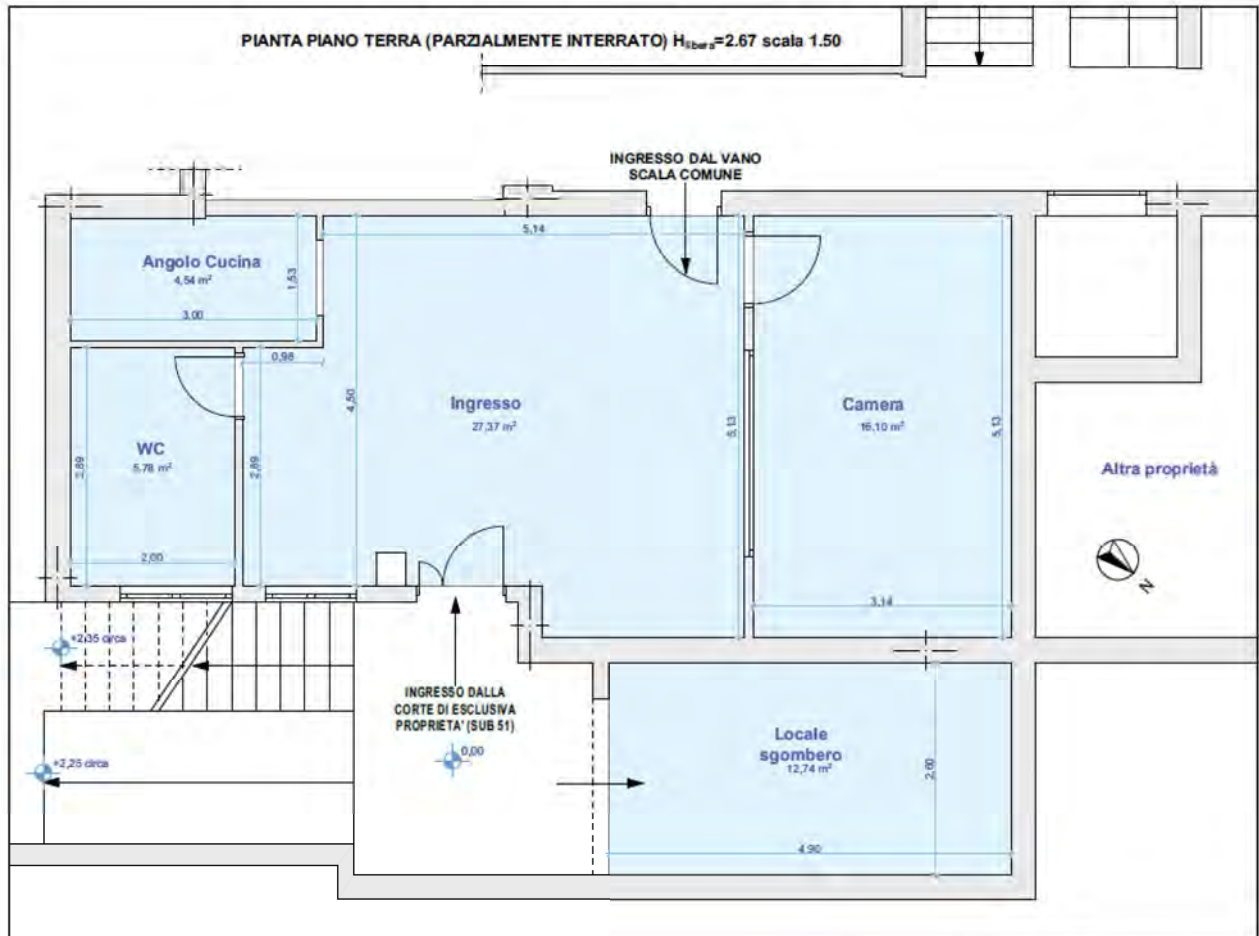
Rilievo metrico dell'appartamento oggetto di pignoramento con indicazione delle superfici nette – piano terra.
